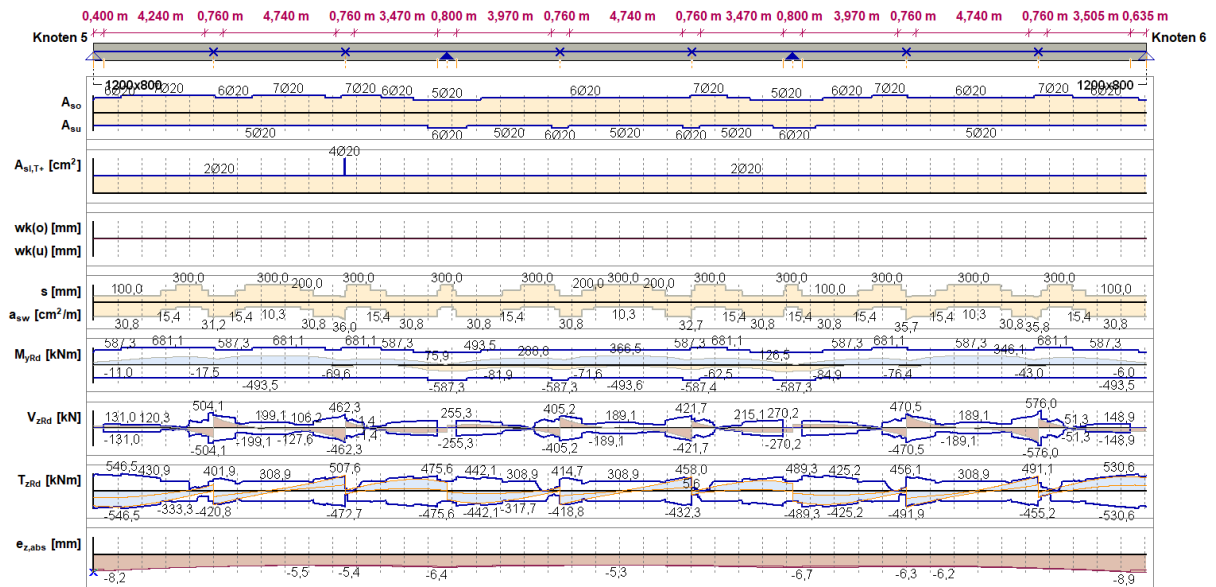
Berechnete Balkenbewehrung, Achse E, vertikale Ebene
